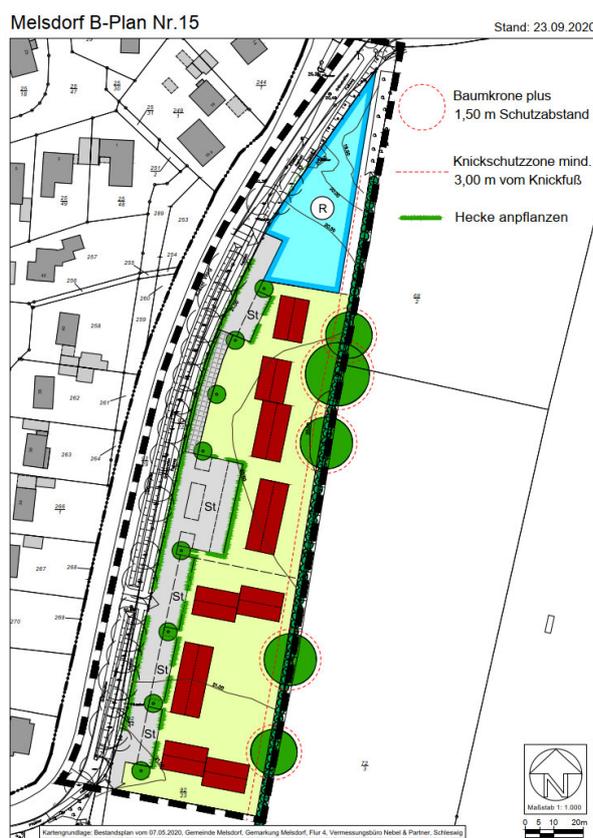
Bebauungsvorschlag B-Plan 15 (Planungsbüro GR Zwo; Stand 23.09.2020)
